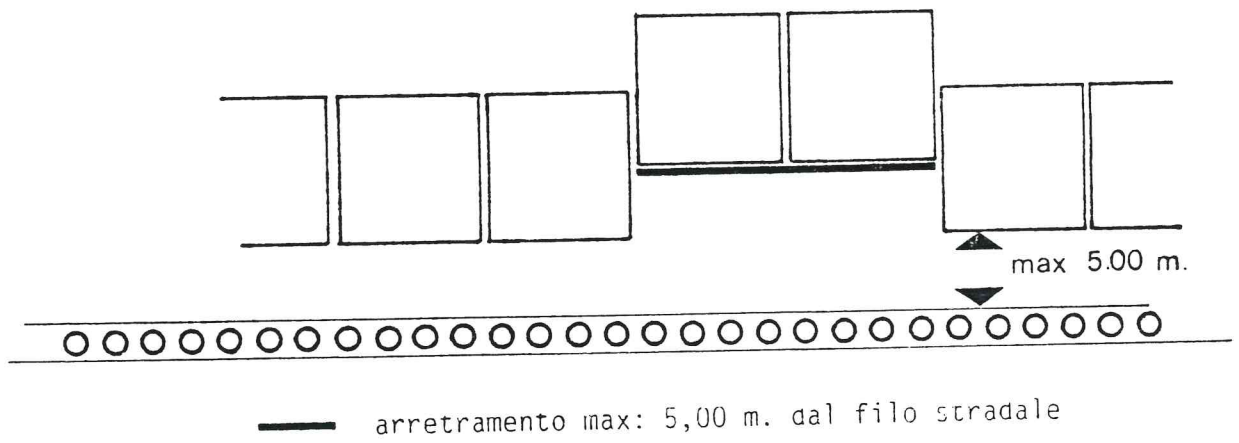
RAPPORTO DEGLI AMPLIAMENTI RISPETTO AI PERCORSI
